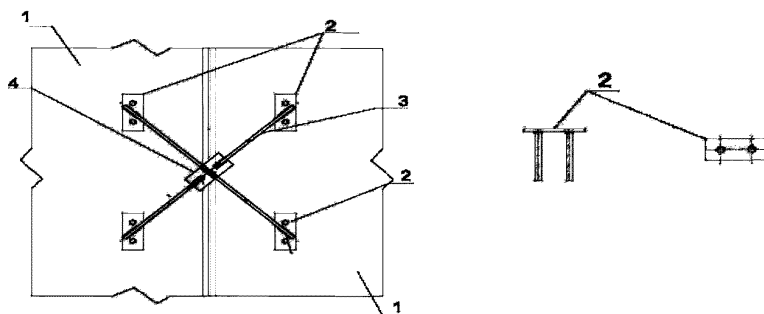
Связи сдвига в ПБФ из арматурных стержней: 1 – плита перекрытия; 2 – закладные детали; 3 – арматурные стержни; 4 – соединительная пластина
